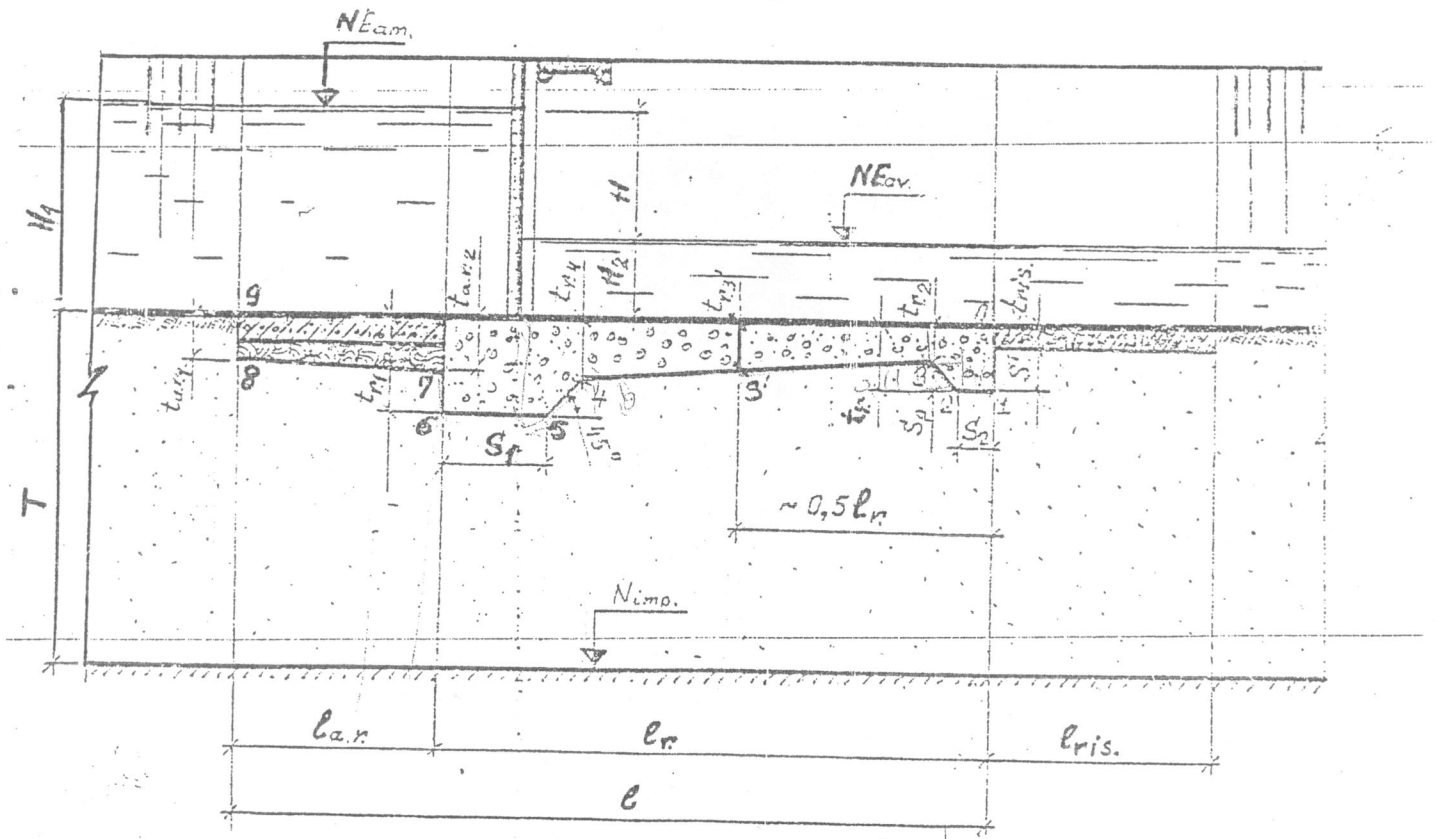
Coupe longitudinale d'un ouvrage régulateur
